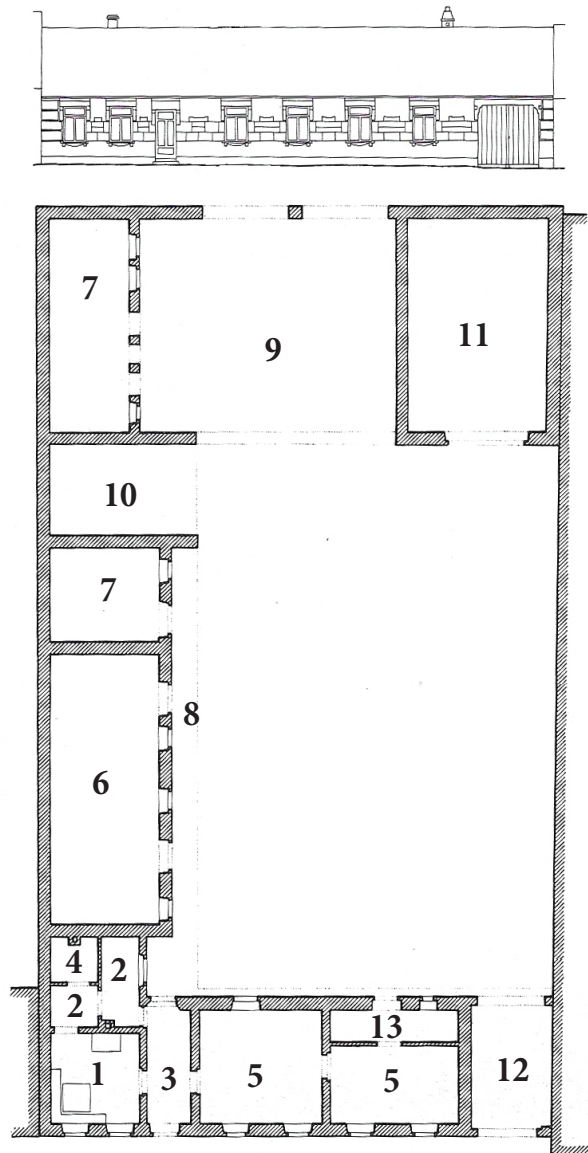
Ein möglicher Grundriss eines Gassenfronthauses
